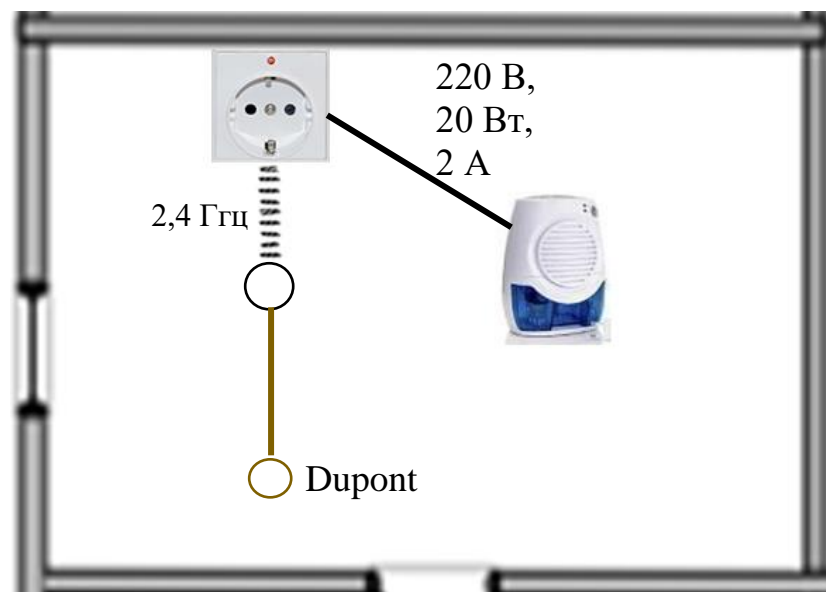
Схема з'єднань другого поверху будівлі
